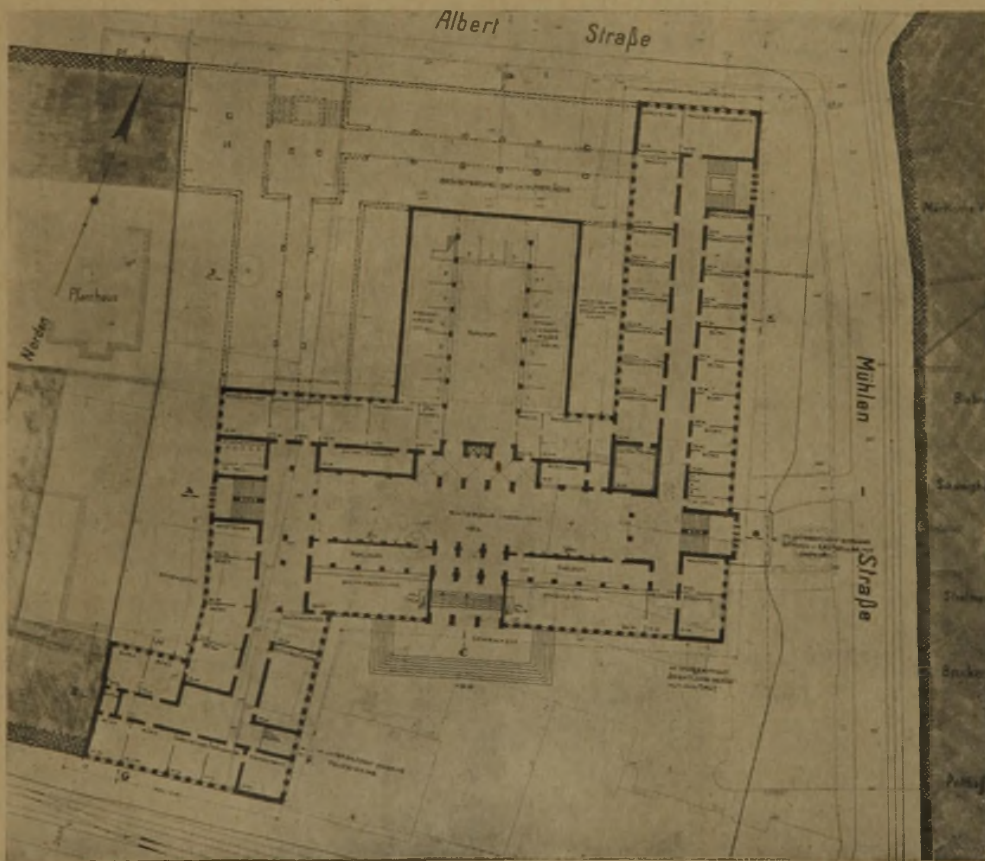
Erdgeschoßgrundriß (1:1000). Ein III. Preis von 7000 M. Kennwort: „Ratsdielen“.
